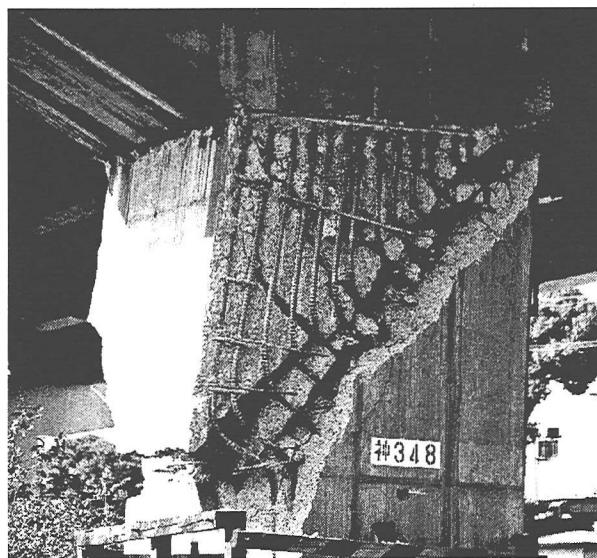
鉄筋コンクリートラーメン橋脚の被災事例（2）
